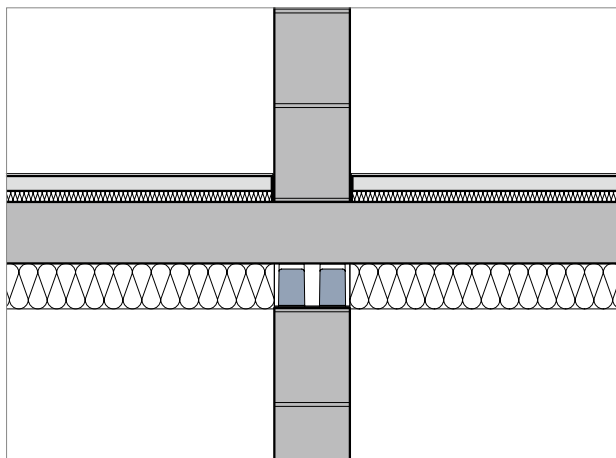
Schöck Sconnex® Typ M in Mauerwerk bei Innenwand und Unterdachdämmung
